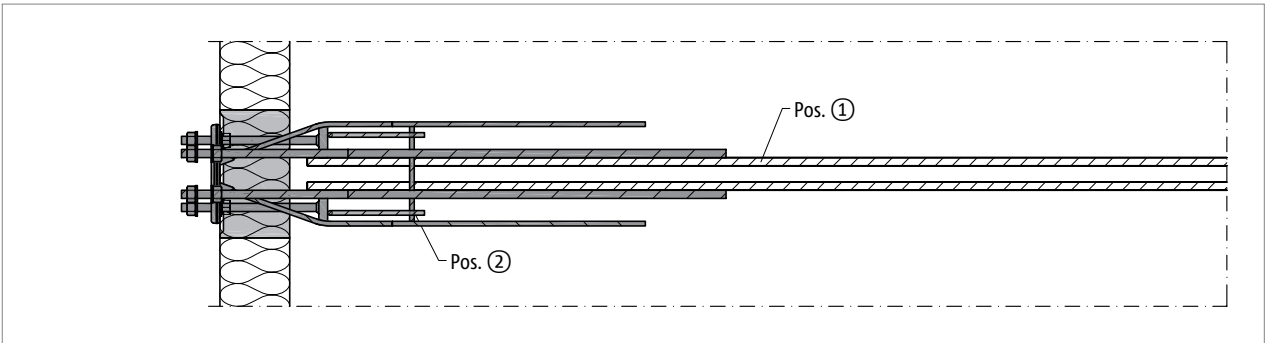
Schöck Isokorb® XT Typ SK-M1: Bauseitige Bewehrung, Grundriss
